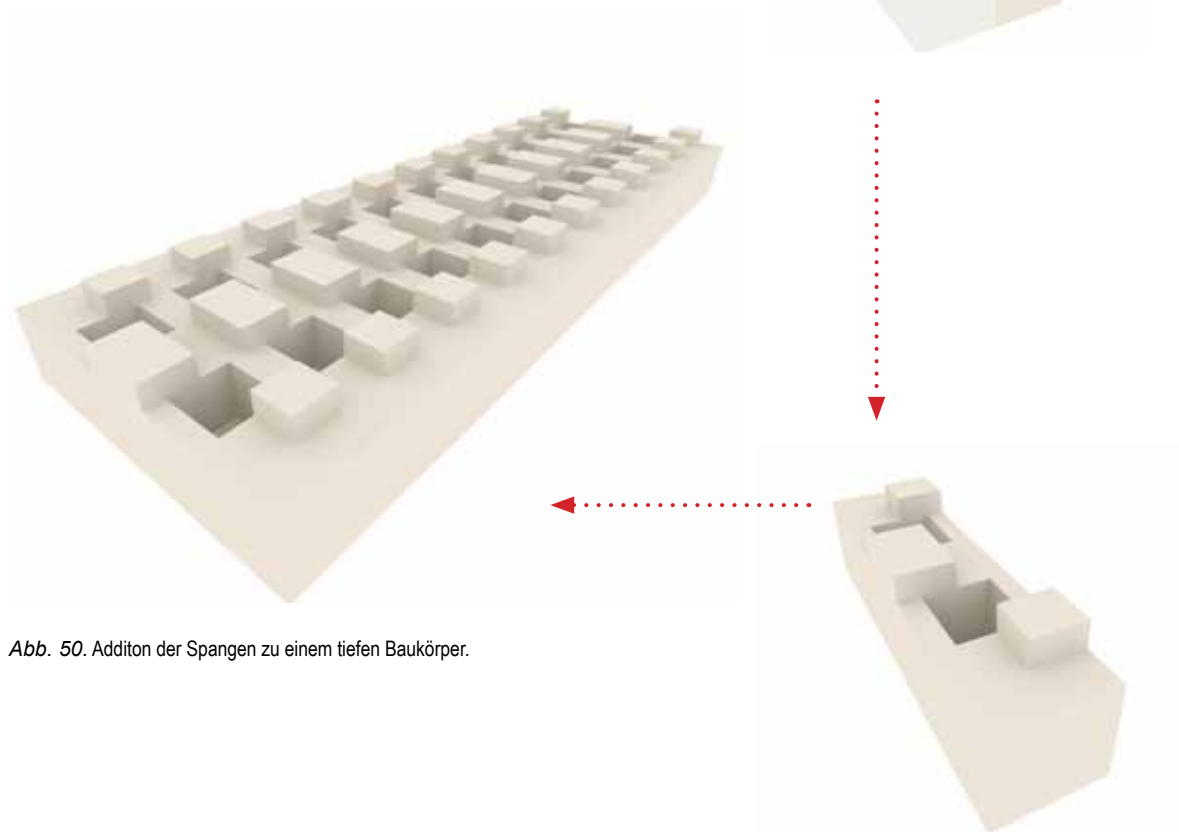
Addition der Spangen zu einem tiefen Baukörper.
